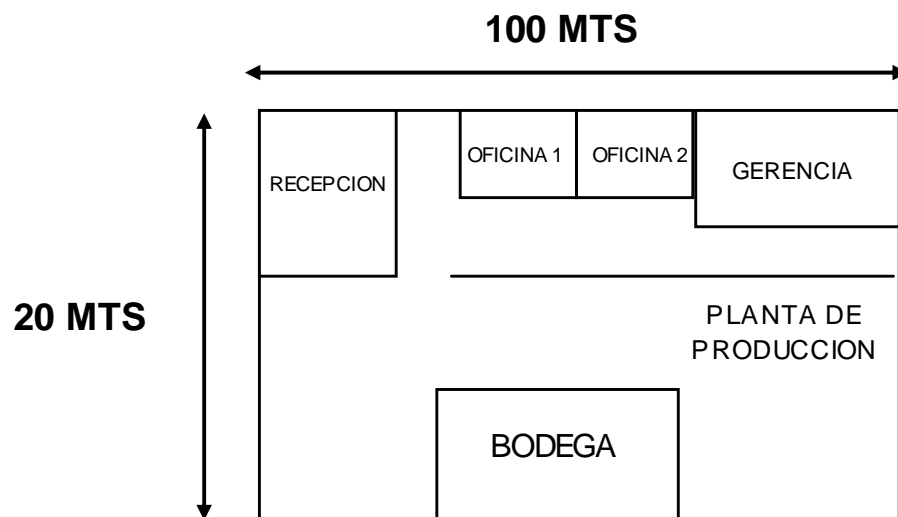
Detalle área administrativa y Planta de Procesamiento.
